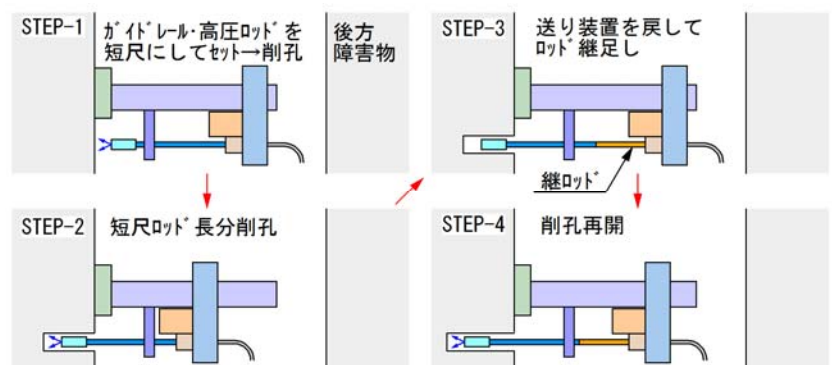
後方の施工空間が狭い場合のWJ 削孔方法概要図(側面図)
